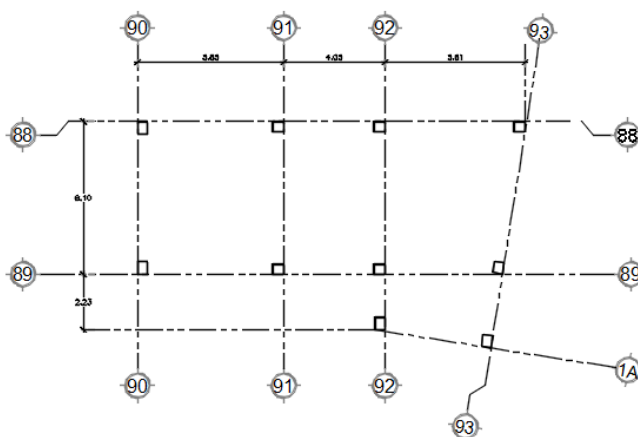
Esquema de planta y ubicación de columnas de la Torre 4
